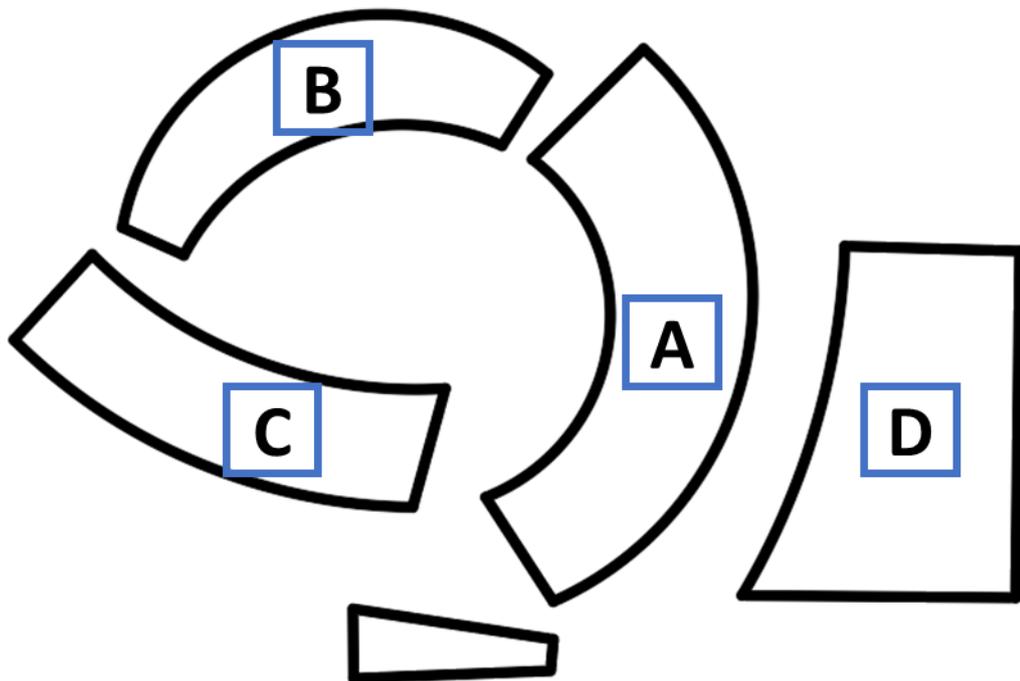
Plano conceptual de la Primera Planta. Fuente: Elaboración propia
